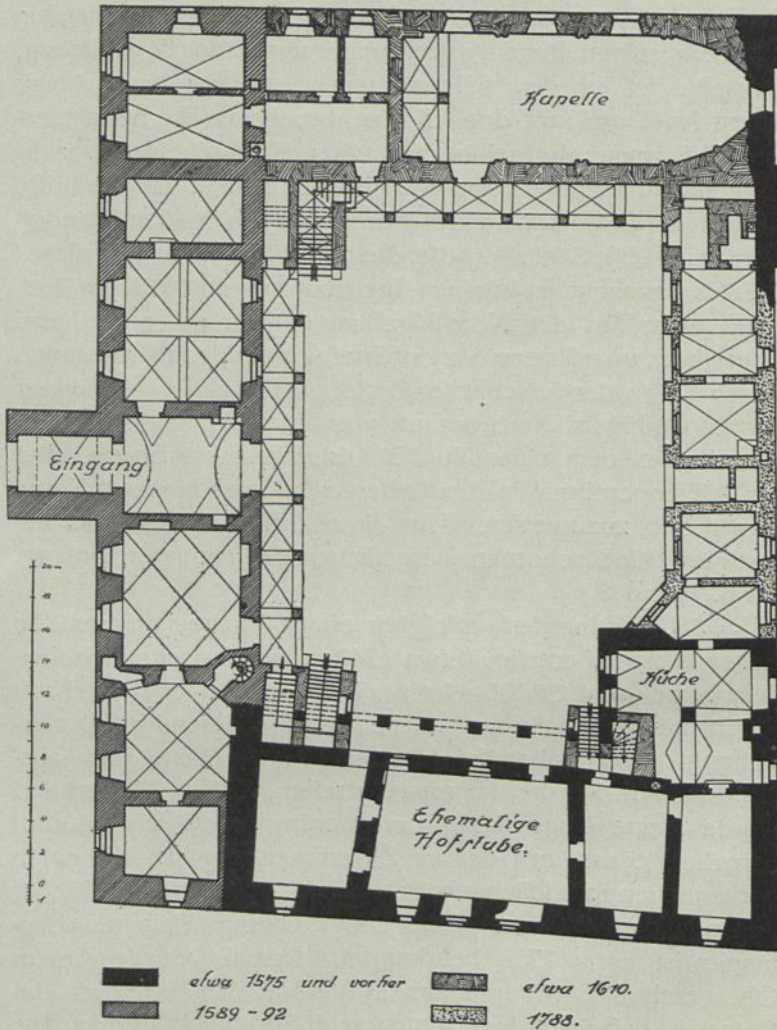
Schloß in Falkenberg O/S. Grundriß des Erdgeschosses.
